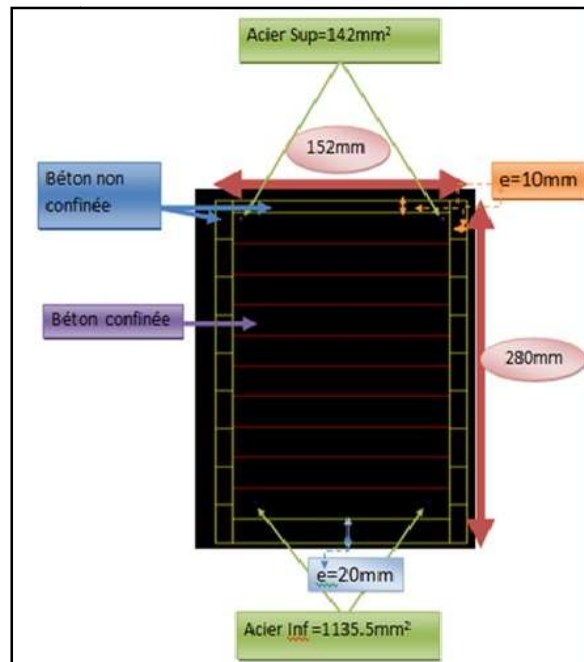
Section transversale du modèle à fibre de la poutre 1
